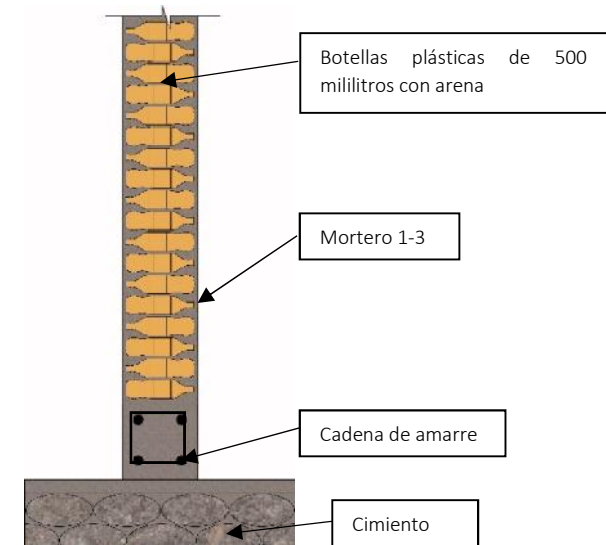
Prototipos “Sistema de aplicación en paredes”
